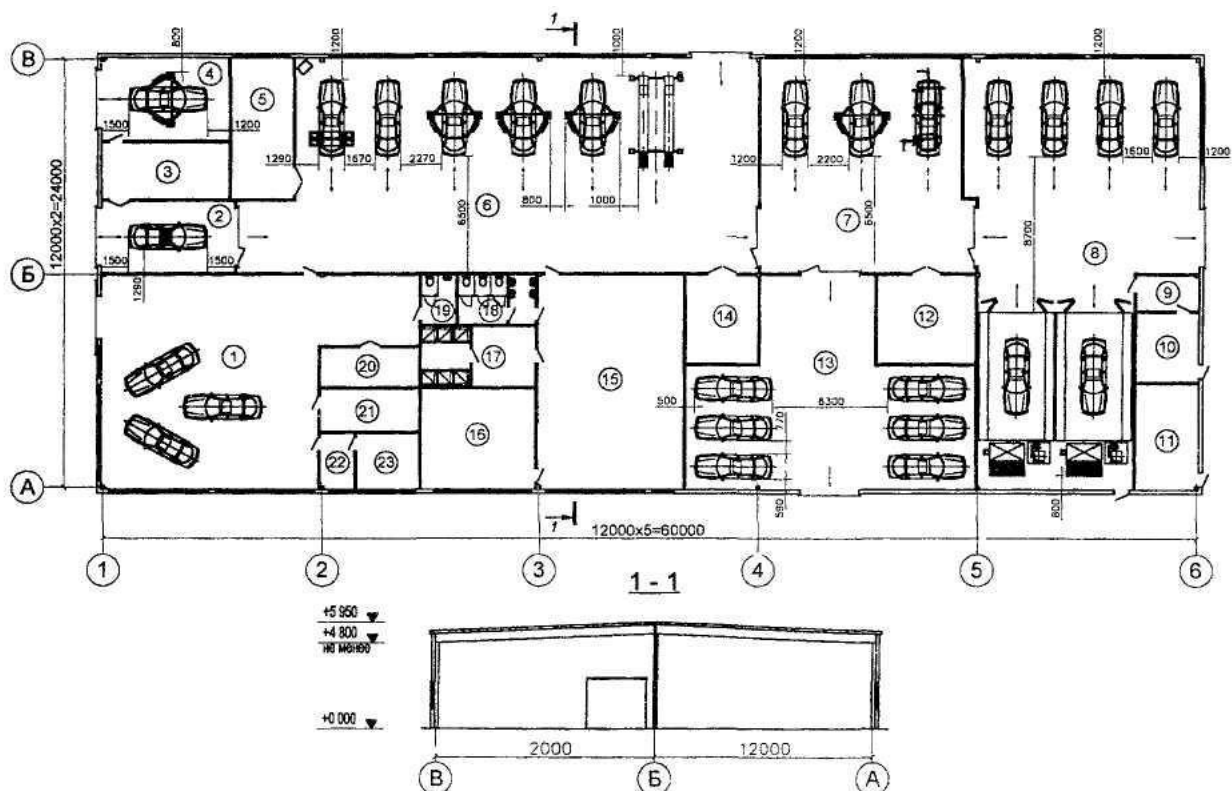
Планировка помещений СТО с расстановкой оборудования
